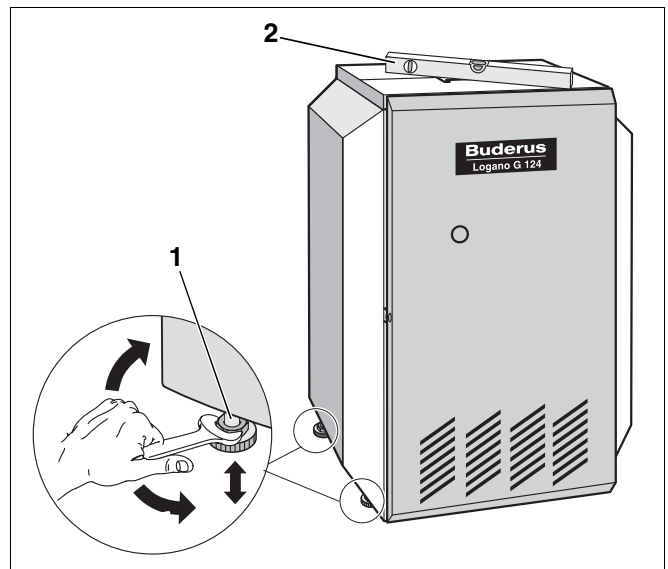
Heizkessel mit Fußschrauben ausrichten
